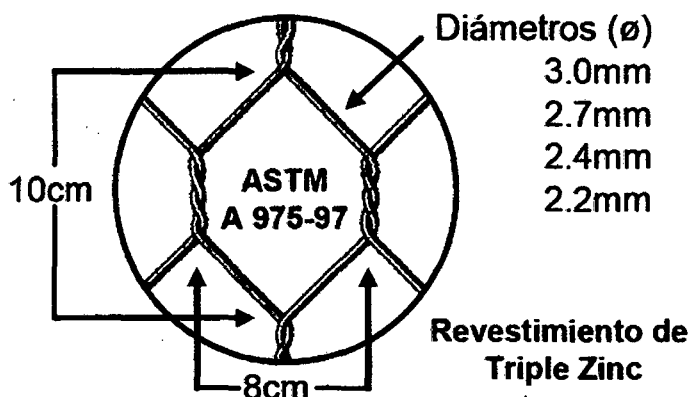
Gavión tipo caja o colchón antisocavante galvanizado
